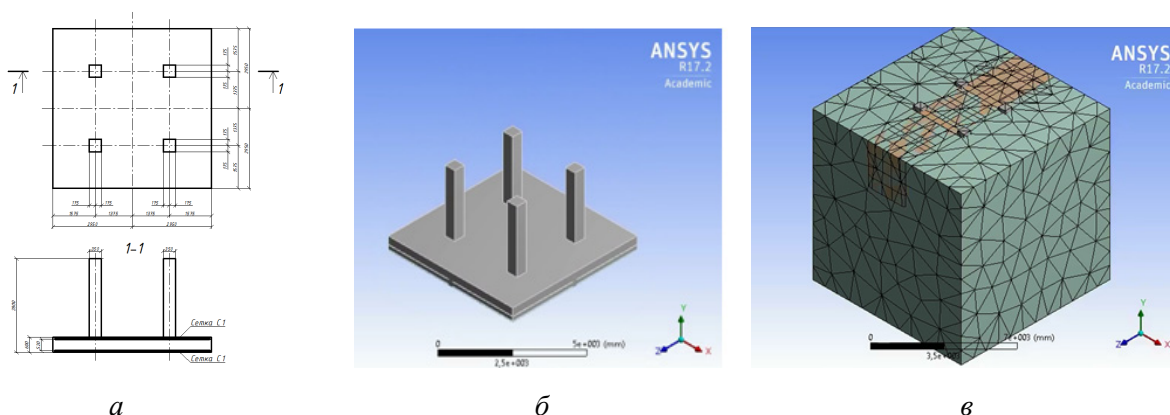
Монолитный фундамент под опору ЛЭП: *a* – геометрические размеры фундамента; *б* – трехмерная модель фундамента; *в* – трехмерная модель фундамента с грунтовым основанием
